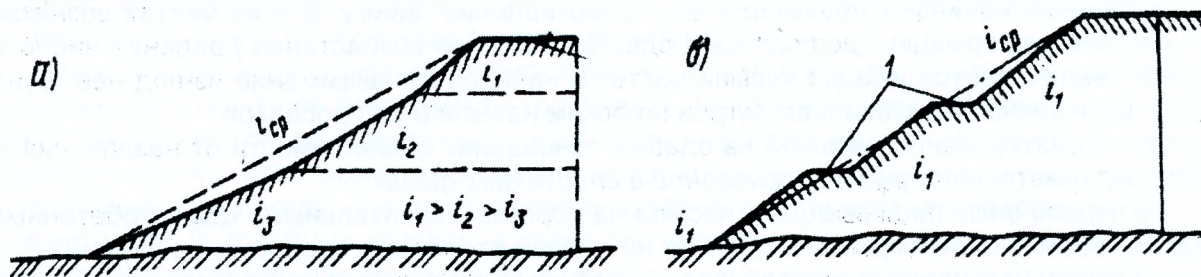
Поперечные профили высоких насыпей: а – с переменной крутизной откосов; б – с введением берм; 1 – берма
